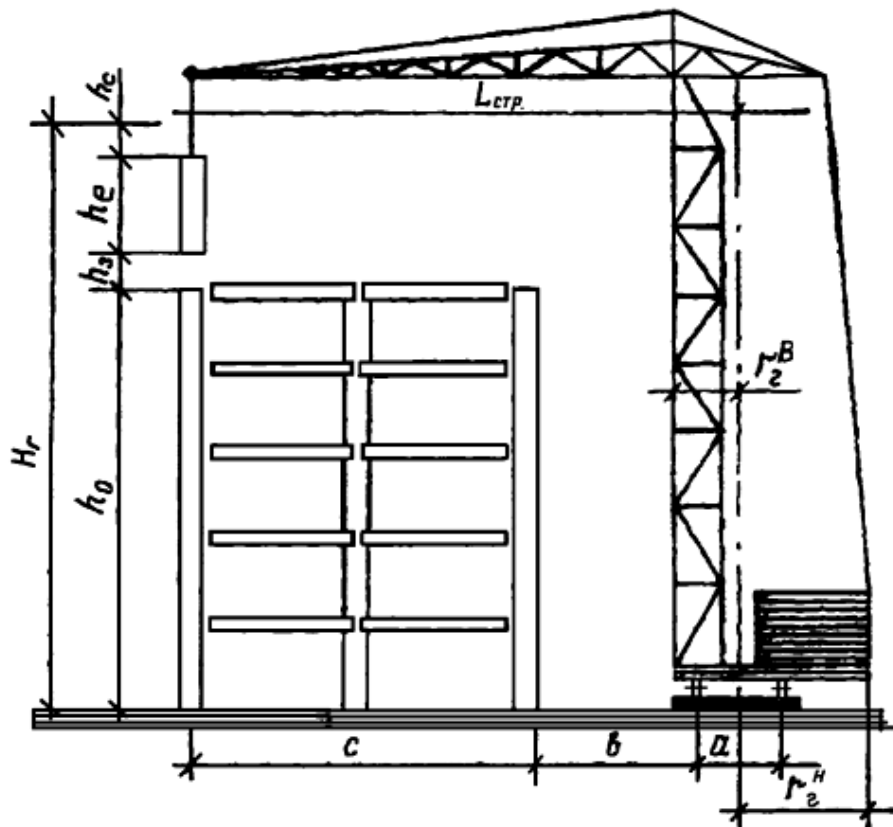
Схема визначення монтажних характеристик баштового крана
